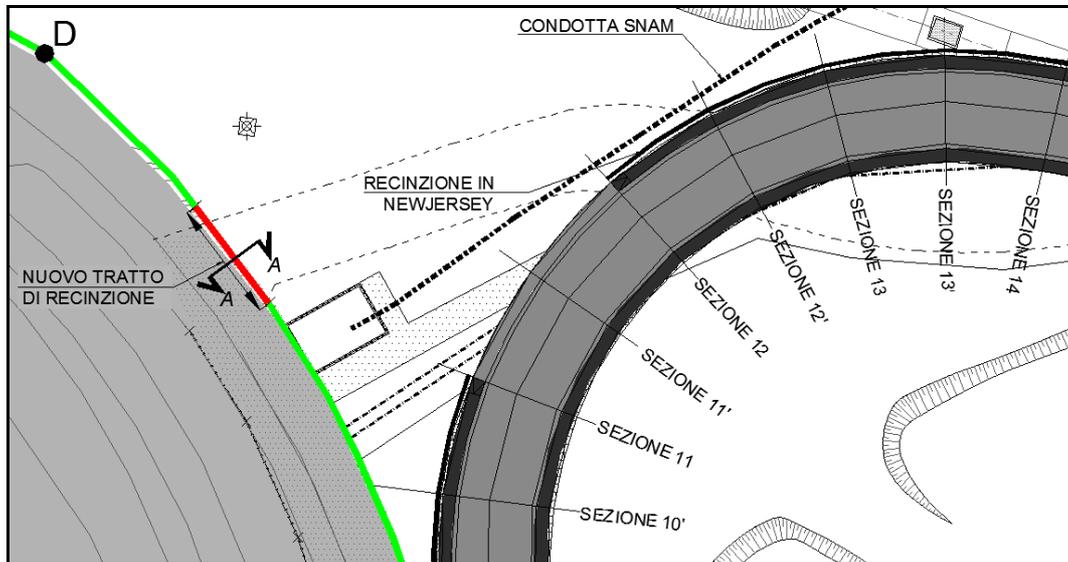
Stralcio planimetrico con individuazione del nuovo tratto di recinzione dello stabilimento ILVA.
